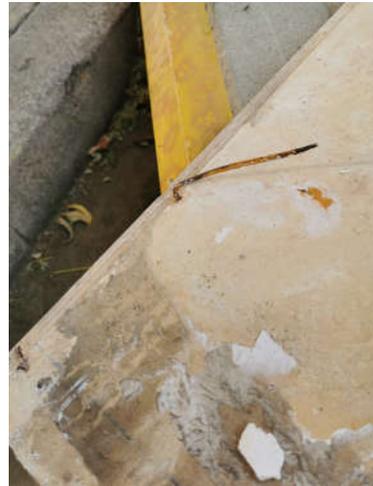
Pieza retirada con canto de forjado de homigón adherido a la pieza de aplacado.
